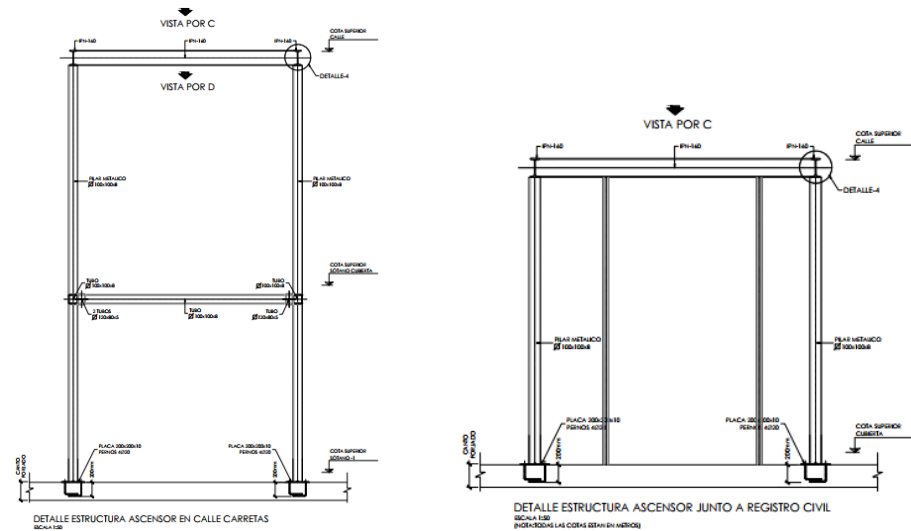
Estructura metálica para ascensor junto acceso a calle Carretas
